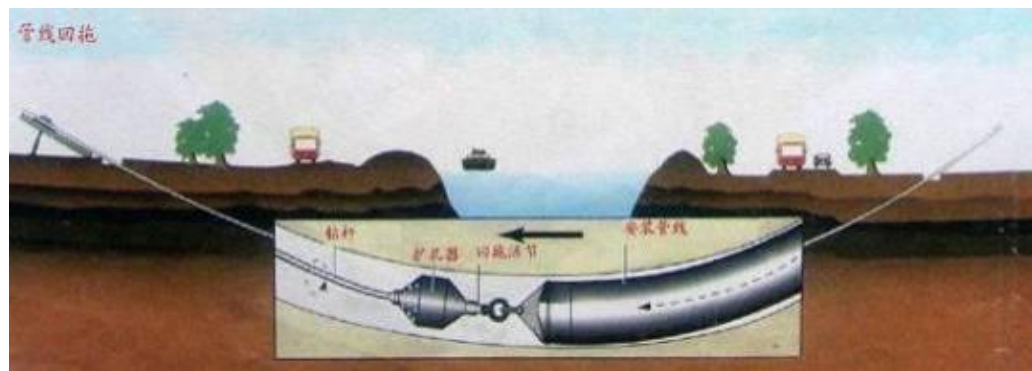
定向钻穿越施工管线回拖工程断面示意图
